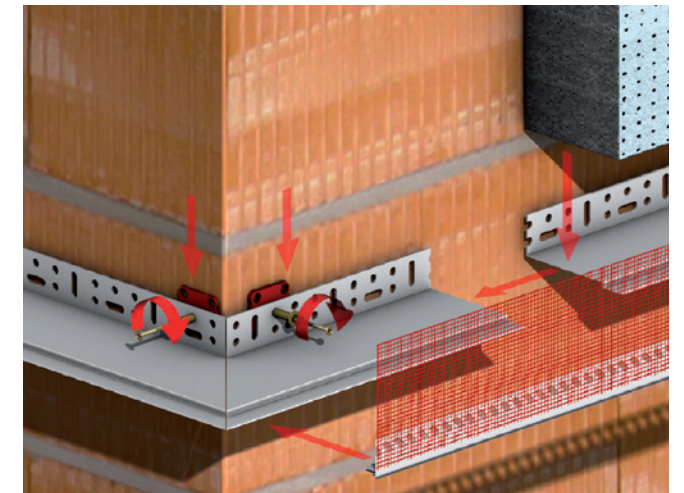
Baumit SockelProfil therm inkl. Tropfkante mit aufgeschweißtem Gewebe und Sockelprofil Montageset
